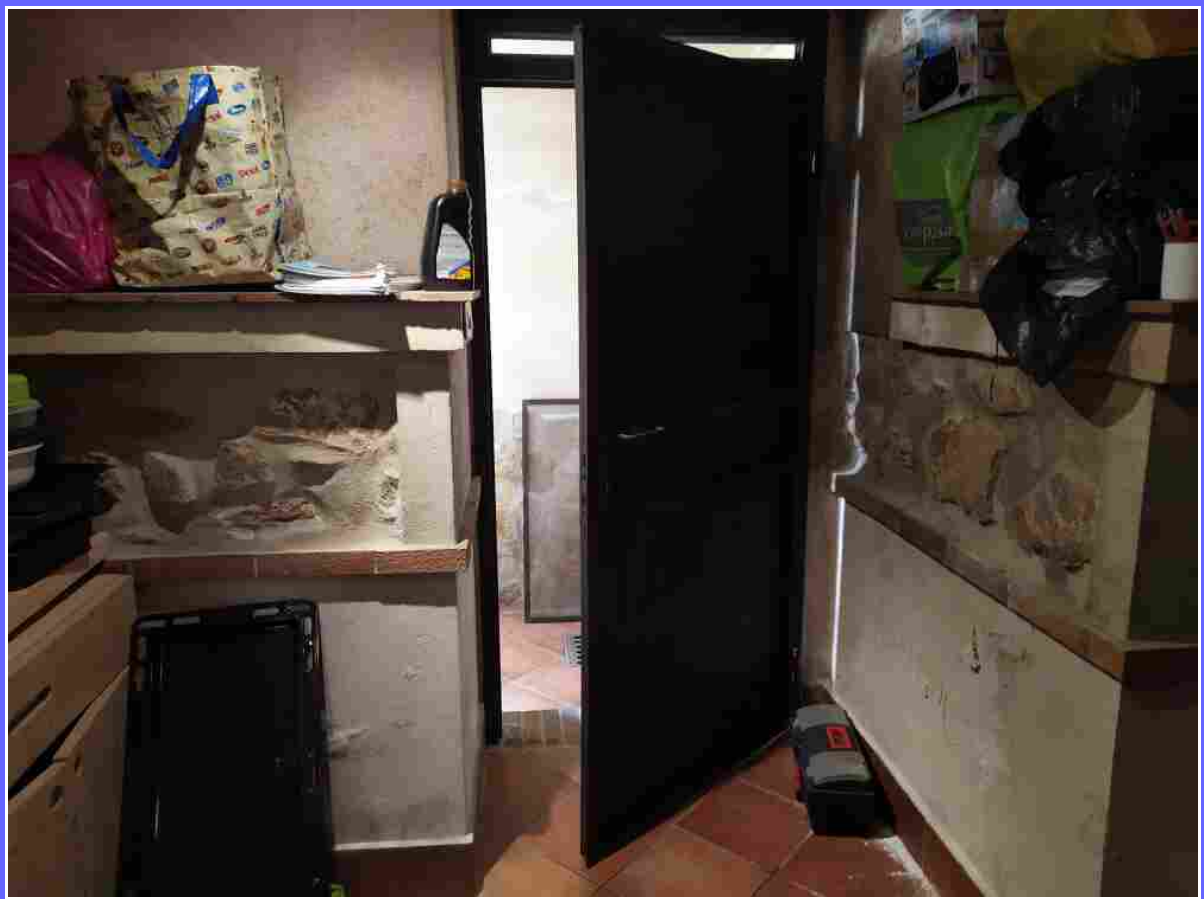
INGRESSO CANTINA - DEPOSITO LOCALE 1 VISTA 4
